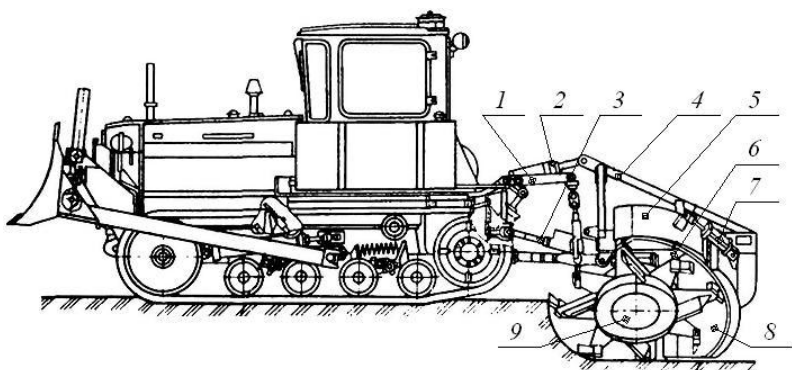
Плужно-фрезерный экскаватор-каналокопатель МК-23: 1 – навесная система трактора; 2 – гидроцилиндр подъема рабочего органа; 3 – карданный вал; 4 – рама рабочего органа; 5 – направляющий кожух; 6 – конический редуктор; 7 – гидроцилиндр управления отбойным щитком; 8 – плуг; 9 – фреза
